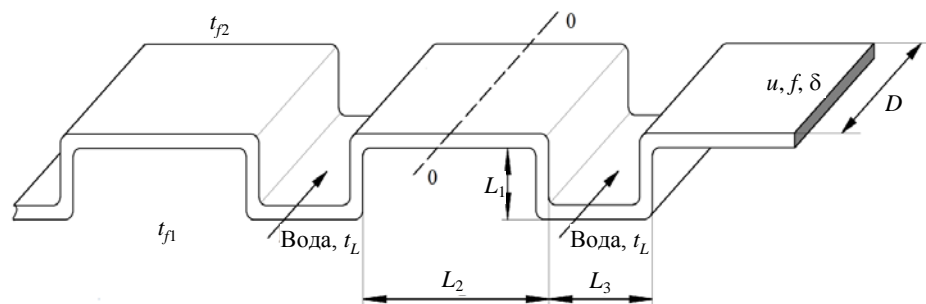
Принципиальная схема конструкции металлочерепицы кровли животноводческого помещения
